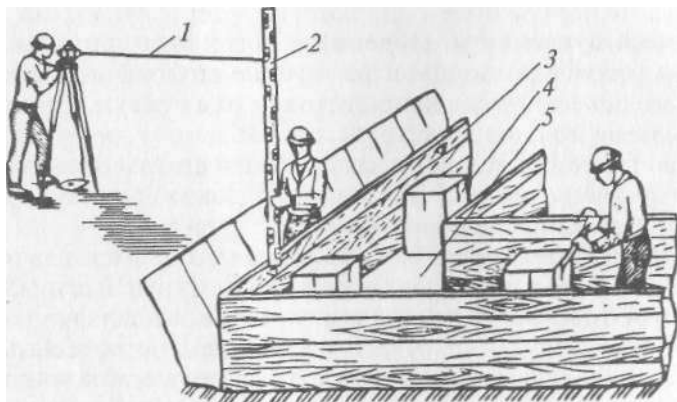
Разбивка осей и отметок для установки арматуры и выверки опалубки (арматура условно не показана):
